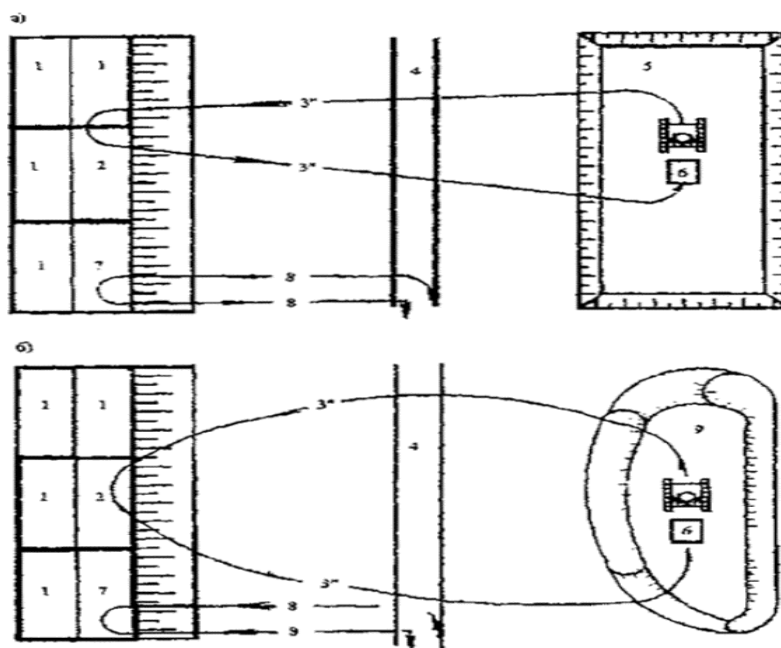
Схема подачи грунта для изоляции ТБО на рабочих картах с помощью скрепера а - при разработке котлована на второй очереди полигона, б - при разработке кавальеров или холмов; 1 - изолированные карты; 2 - изолируемая карта; 3 - трасса скрепера с грунтом; 4 - временная дорога для мусоровозов; 5 - котлован второй очереди полигона; 6 - скрепер; 7 - карта, заполняемая ТБО; 8 - трасса движения мусоровозов; 9 - кавальер или холм грунта.
